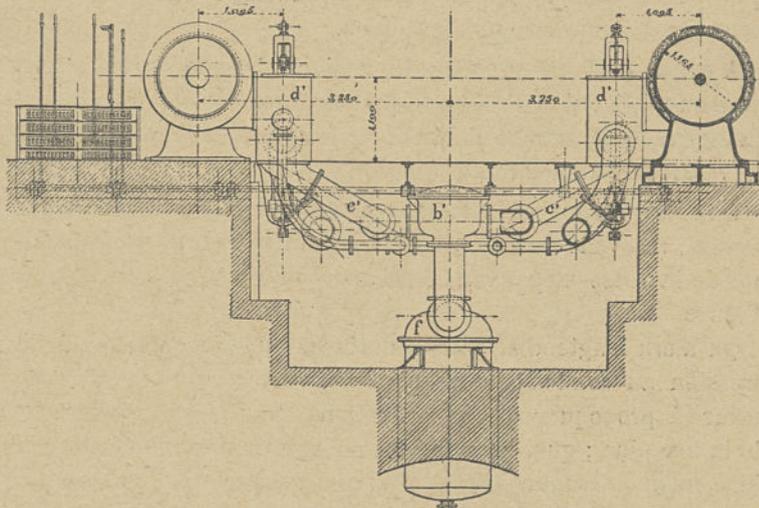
Coupe suivant 3-4 de la machine d'extraction de la fosse d'Arenberg.
